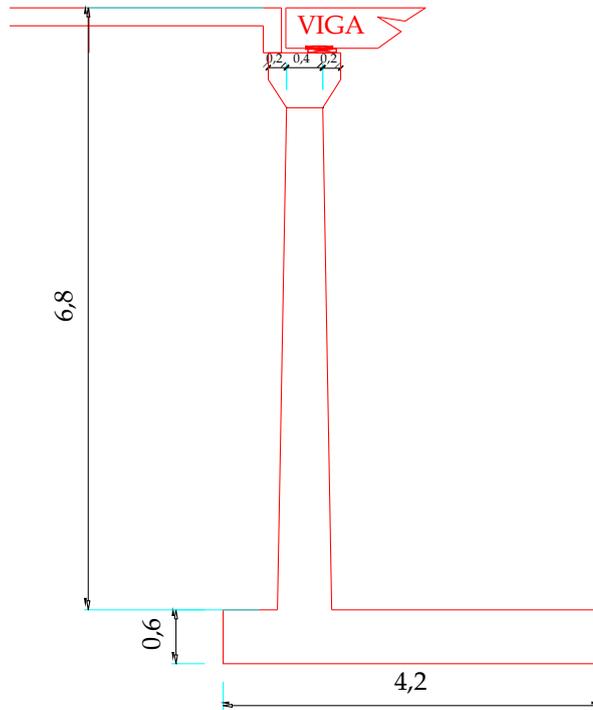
DETALLES DE ESTRIBOS PROPUESTOS EN LA RECONSTRUCCIÓN DEL PUENTE 17 DE SEPTIEMBRE.
